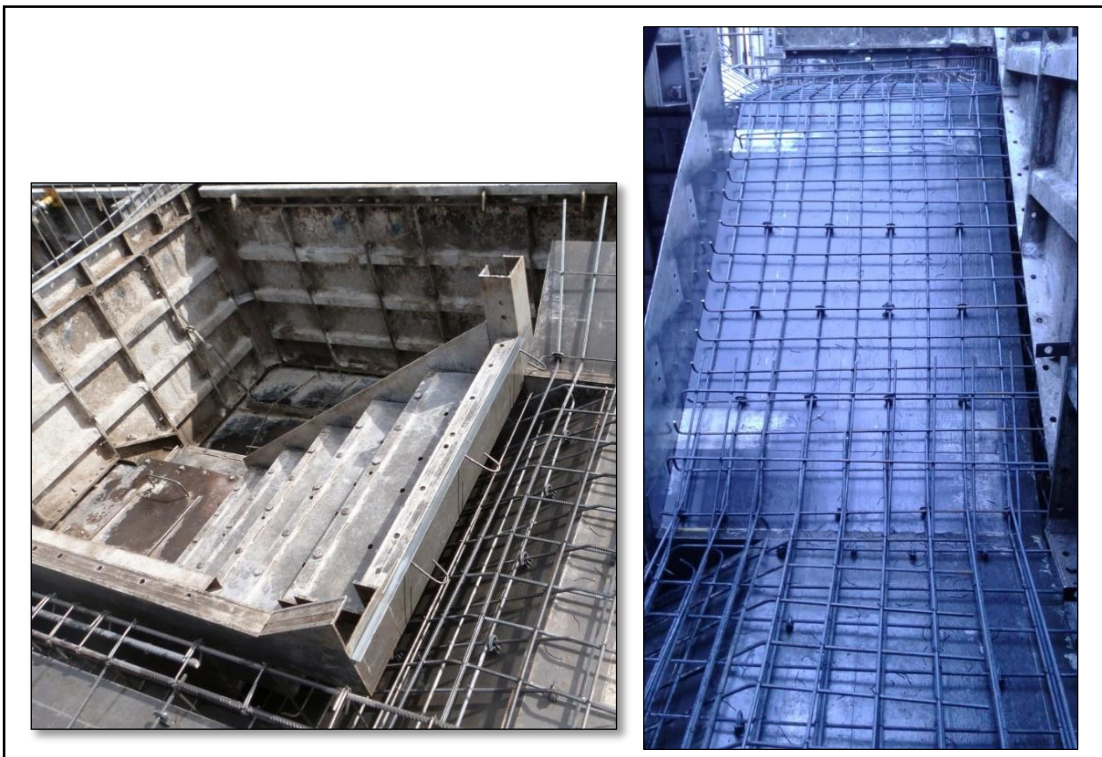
Encofrado y armado de escalera previo a hormigonado.
